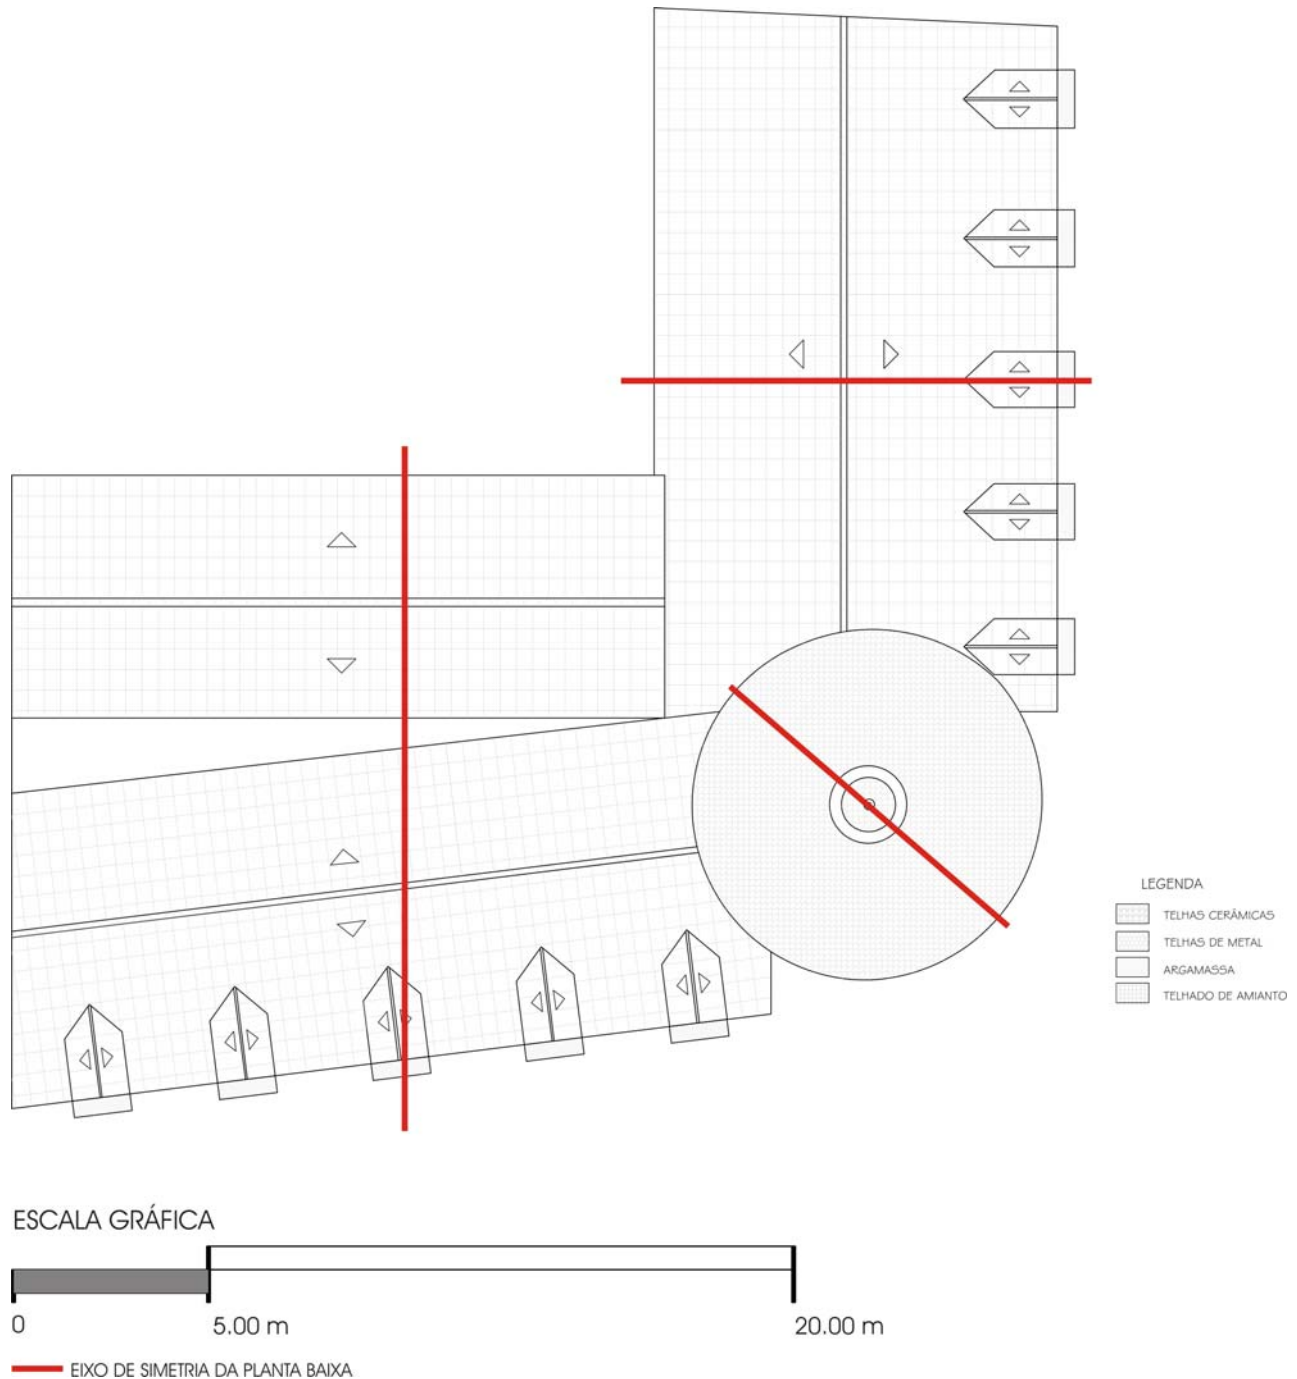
Planta baixa da cobertura – simetria da edificação.
